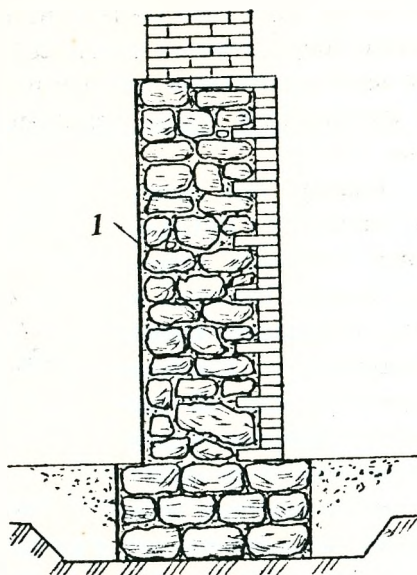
Бутовая кладка с облицовкой кирпичом.
